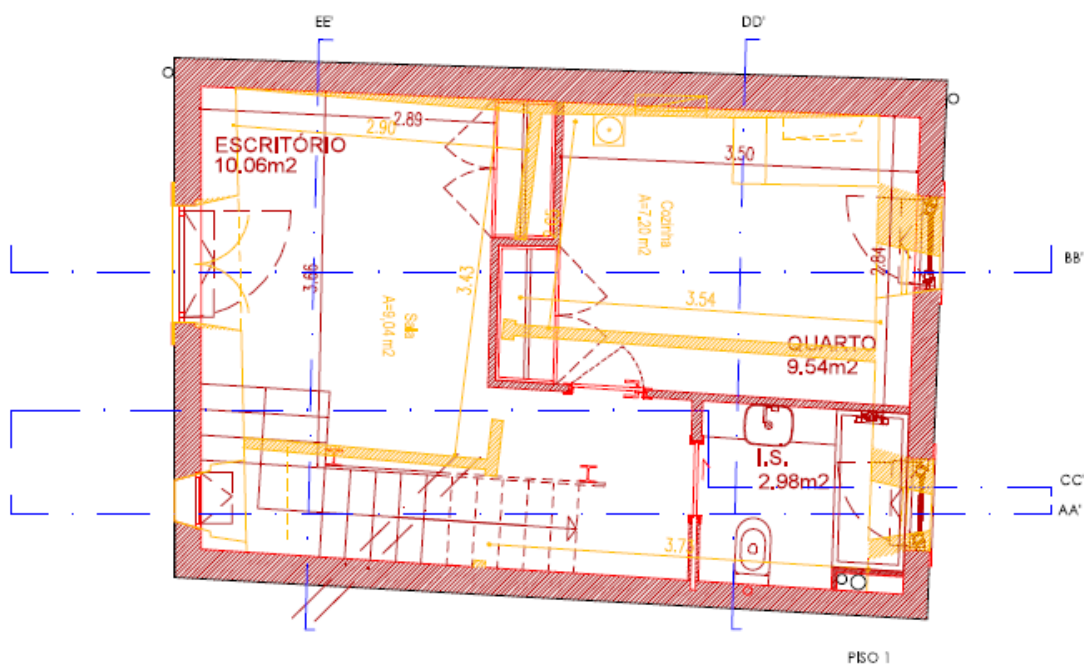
planta de alterações do piso 1 (Seleiro, Cruz, & Moutinho, Demolições e proposto, 2017)
